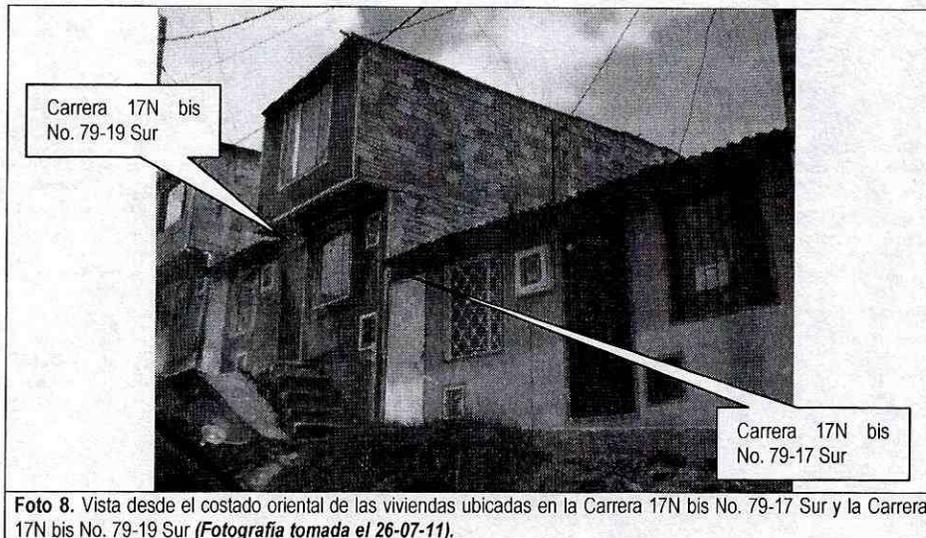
Vista desde el costado oriental de las viviendas ubicadas en la Carrera 17N bis No. 79-17 Sur y la Carrera 17N bis No. 79-19 Sur (*Fotografía tomada el 26-07-11*).
